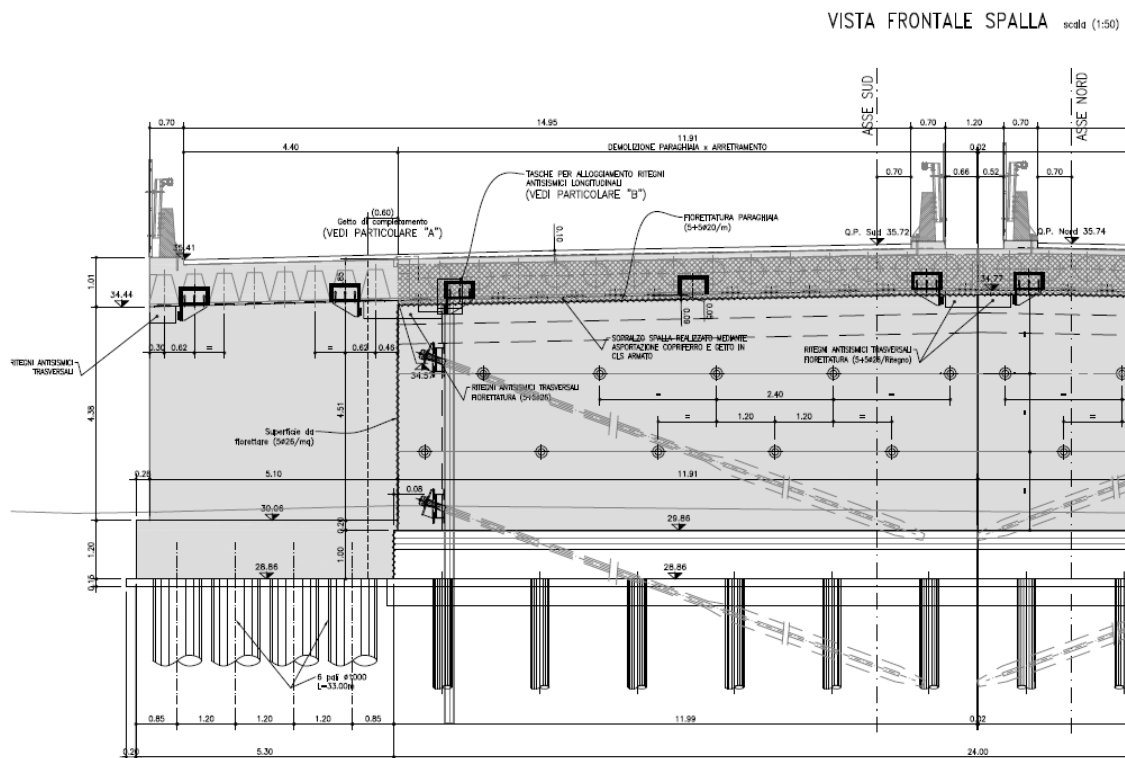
Semi-prospetto spalle con ampliamento
